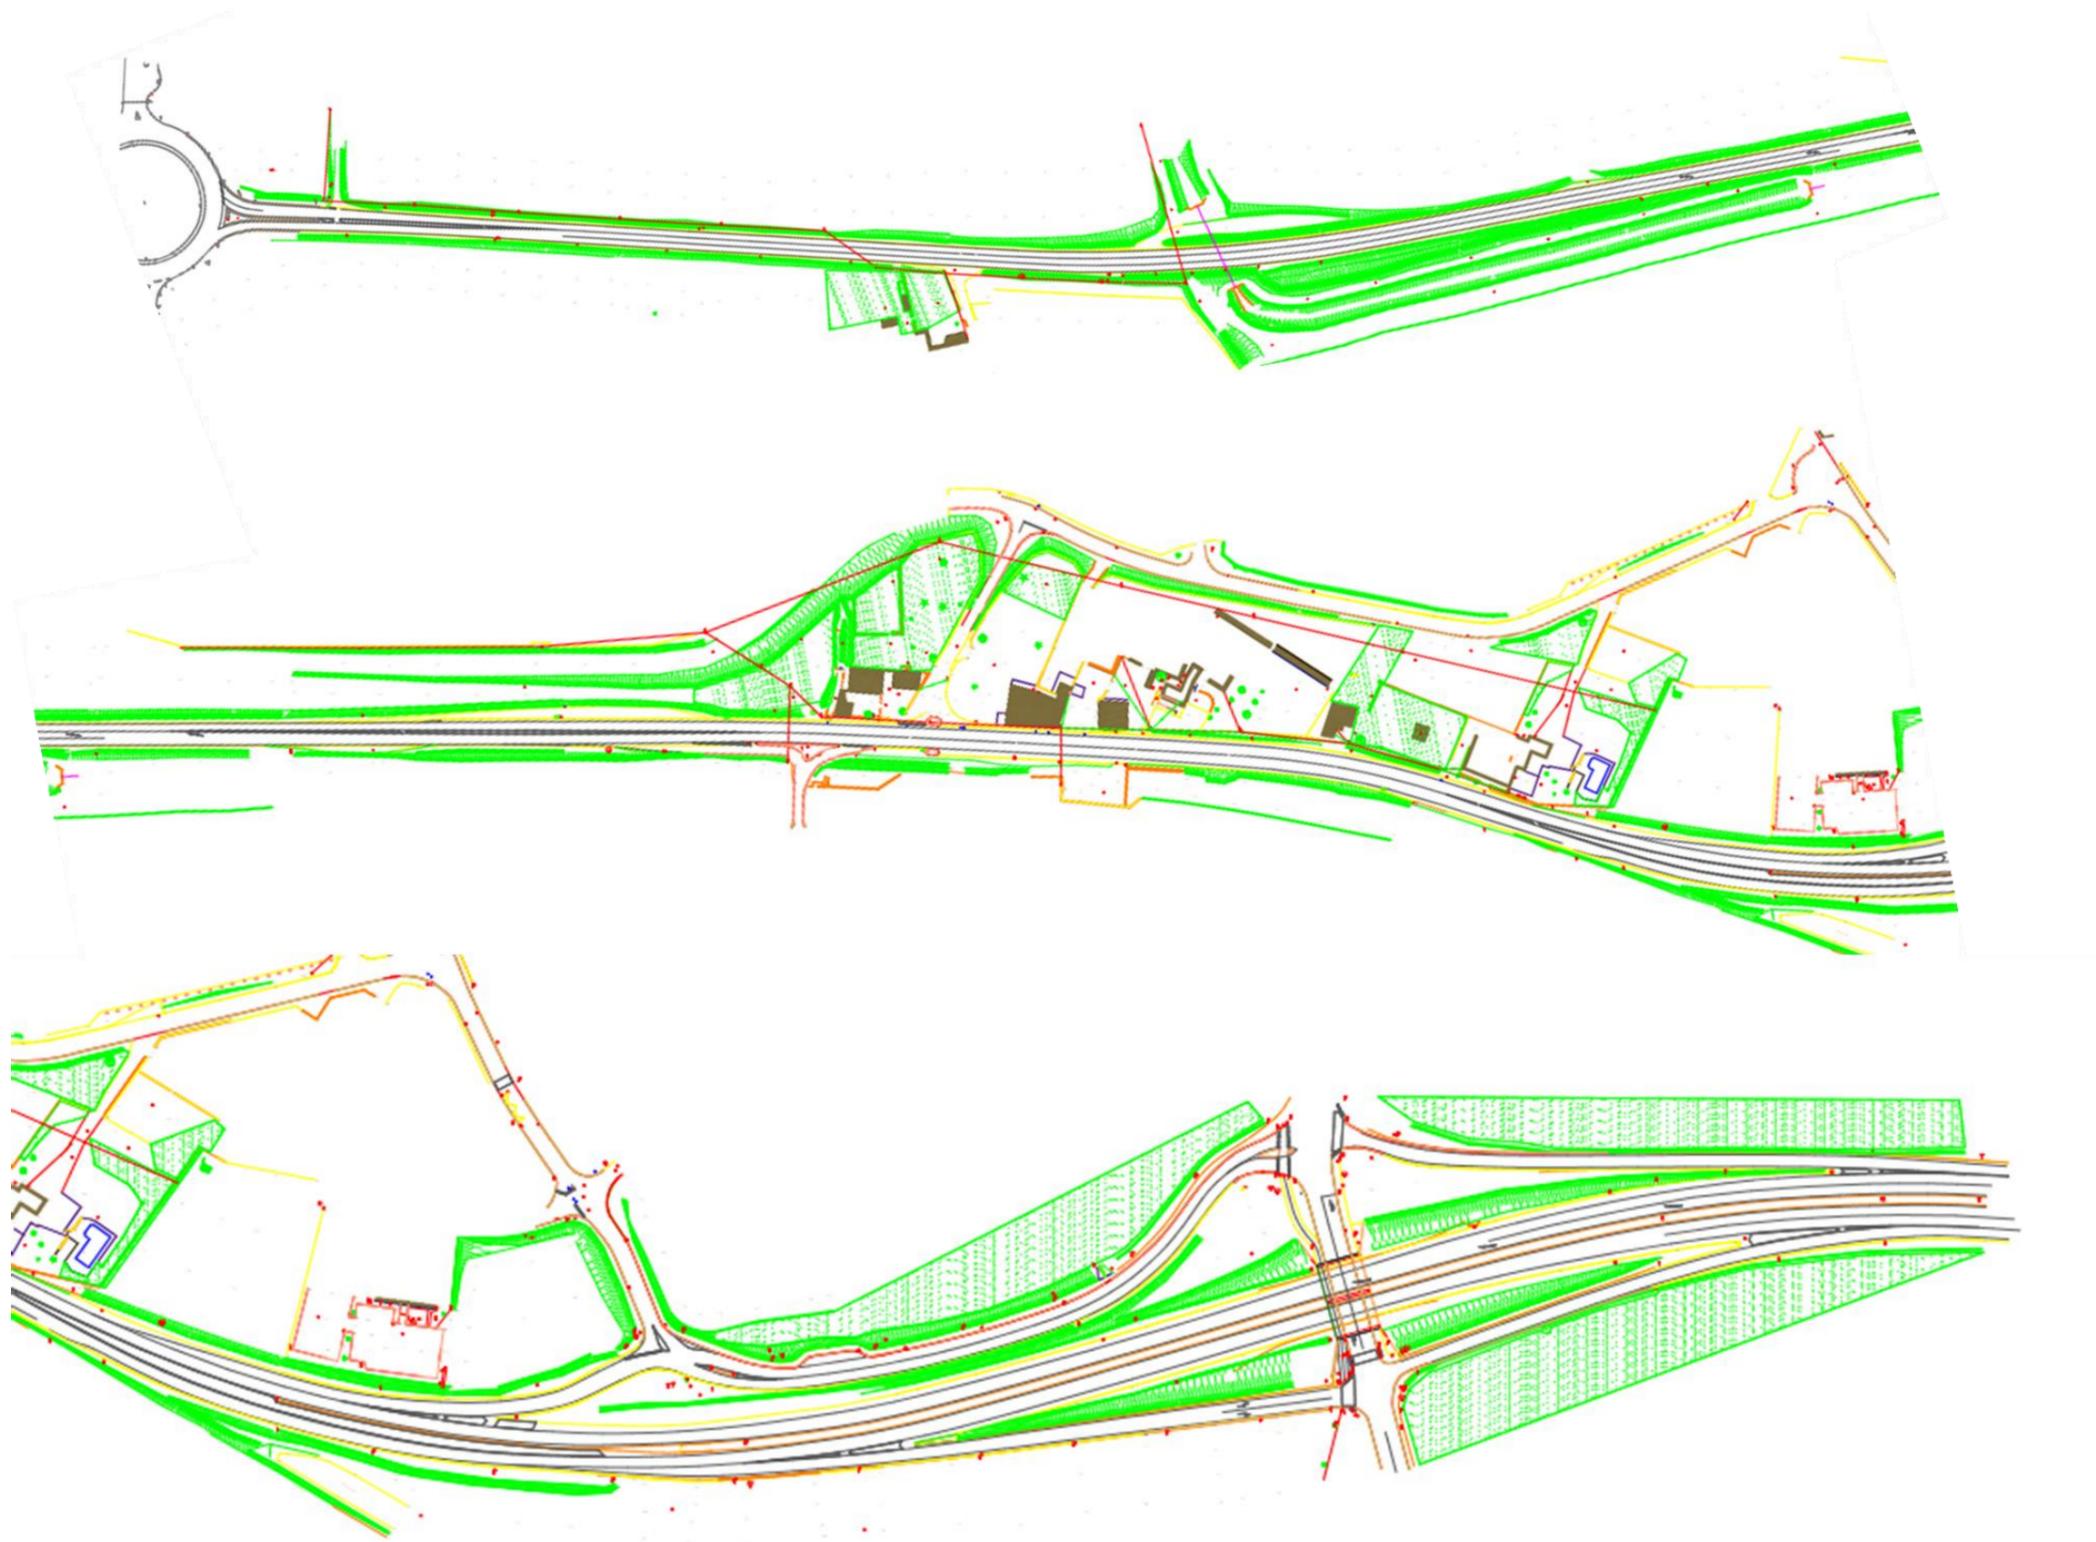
Extrait du plan topographie au droit du site (Source : Département de l'Isère)
